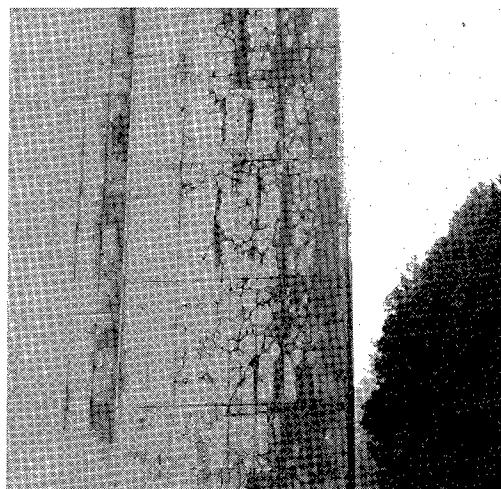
コンクリート橋脚のひび割れ発生状況
